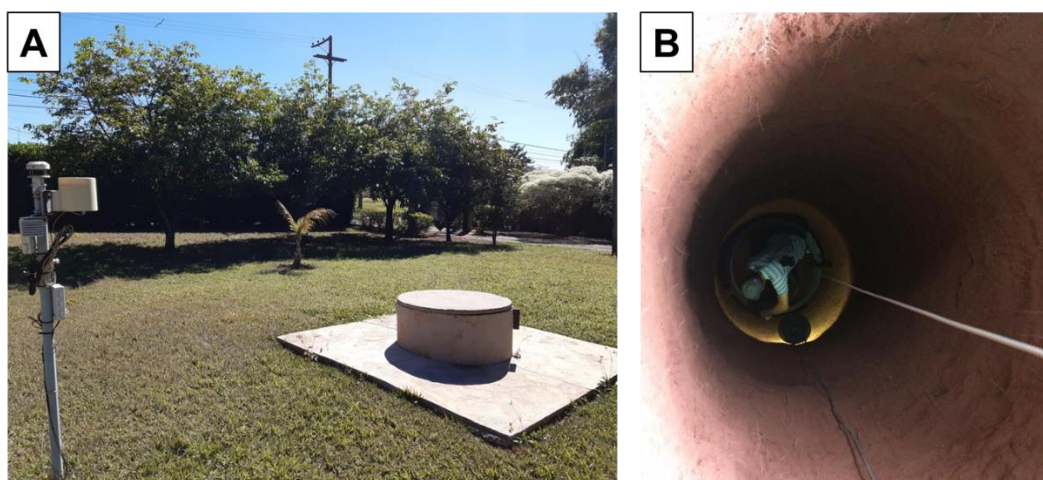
(A) Local de instalação do poço, ao lado da estação meteorológica; (B) Escavação do poço de monitoramento.
